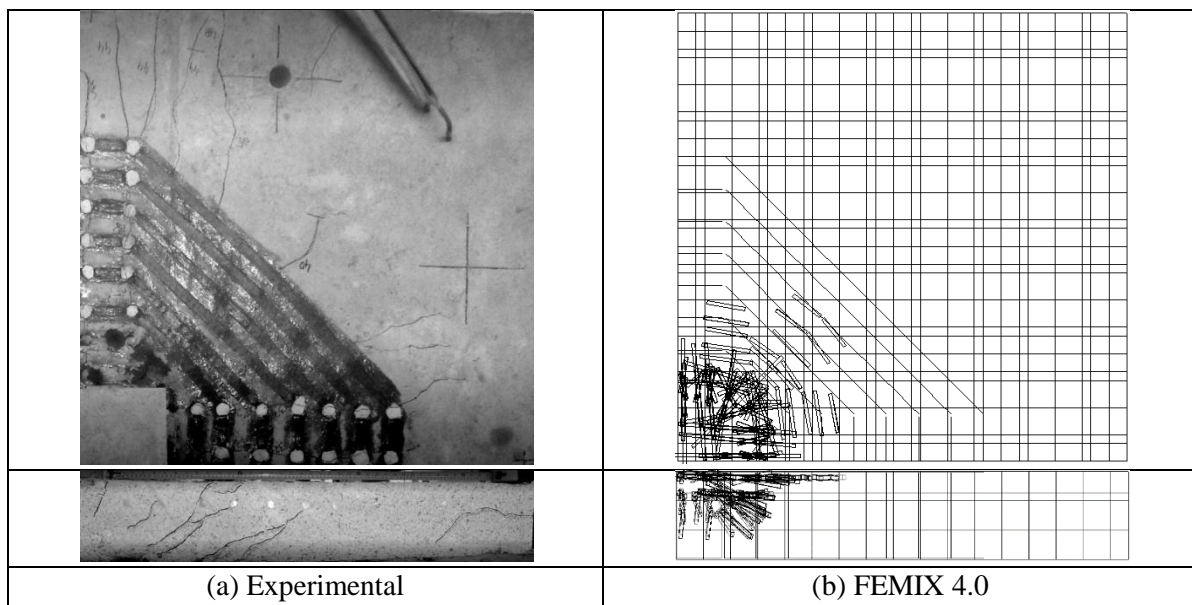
Padrão de fissuração - LC-S2-8 (FEMIX 4.0)
